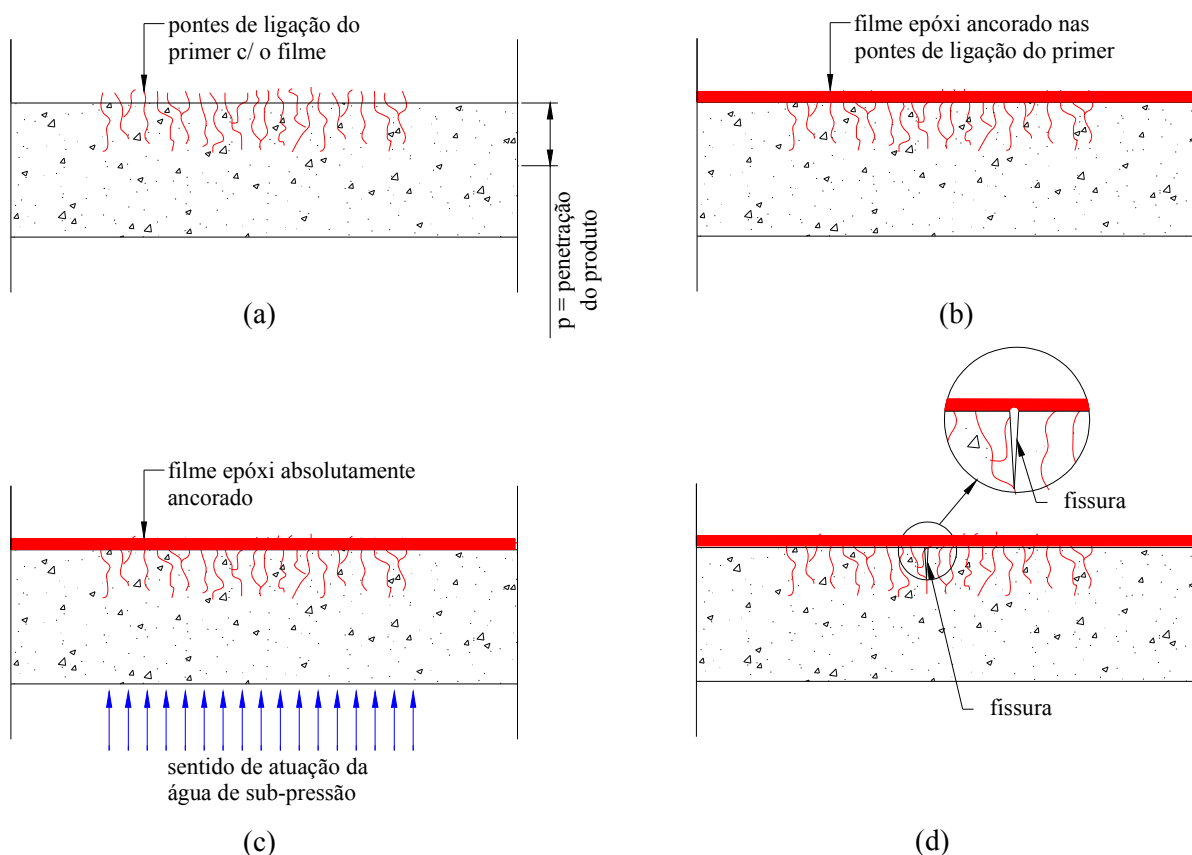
Detalhe do sistema (a) Aplicação do primer (b) Aplicação do filme epóxi (c) Sentido da atuação de sub-pressão (d) Limite de fissura.
